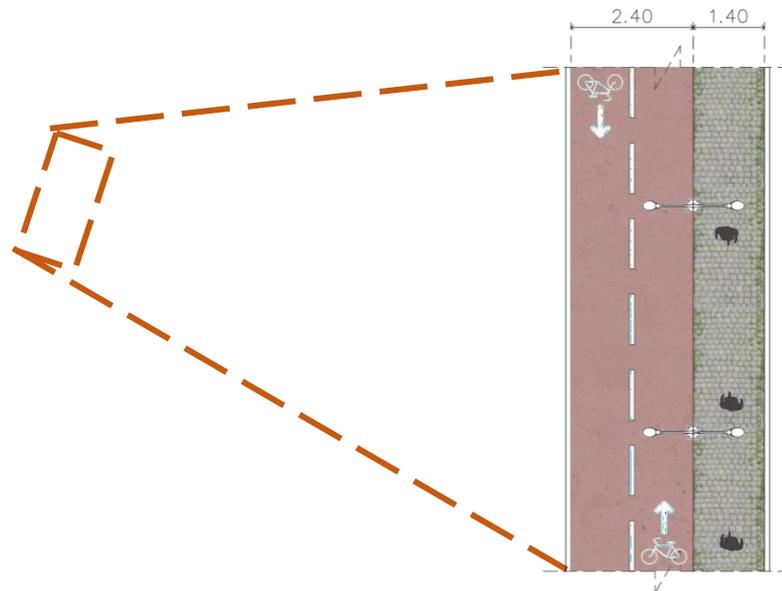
Propuesta puente planta detalle 2.1 - Tramo 2
